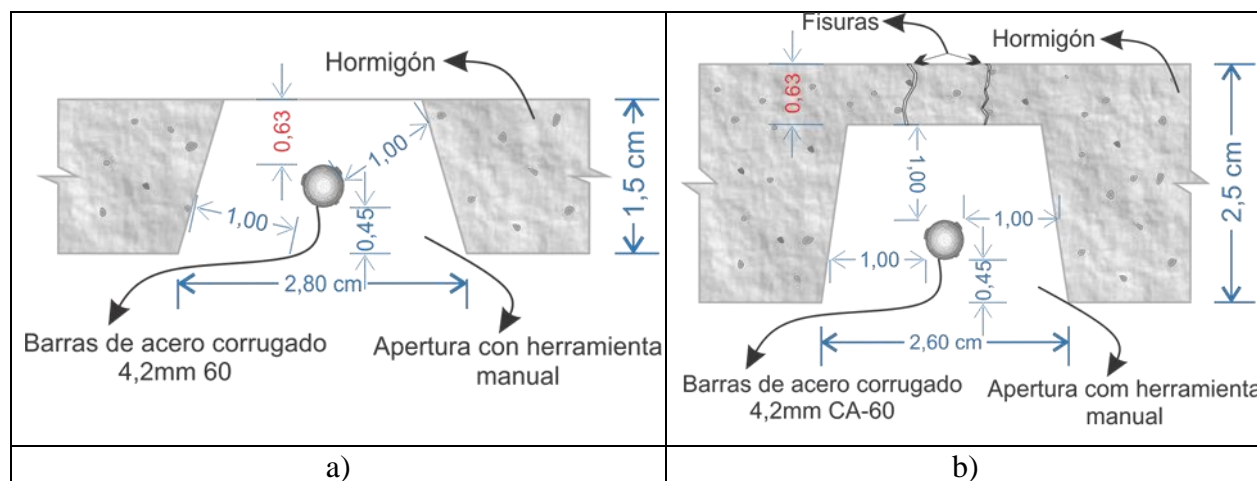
Detalle de la posible recuperación: a) modelo abierto; b) modelo cerrado
